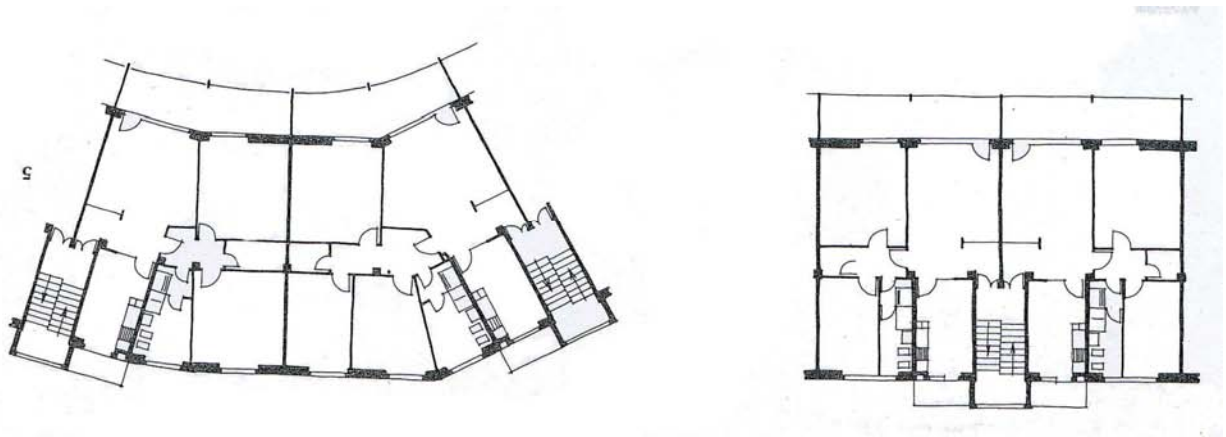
Piante dei piani tipo degli alloggi di Forte Quezzi
